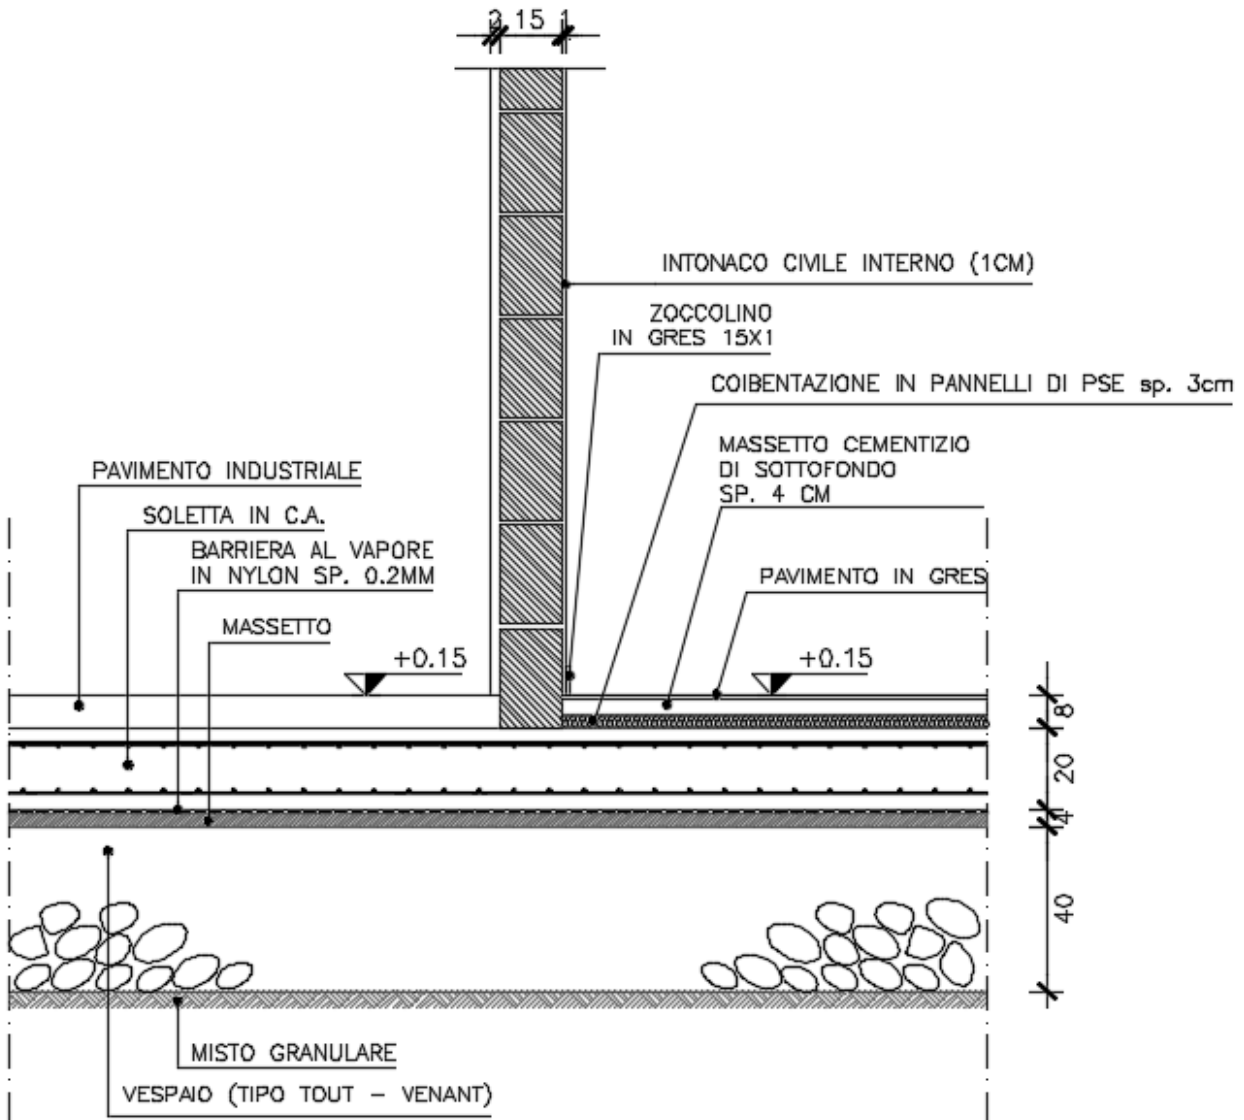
Particolare pavimentazione tra officina e locale batteria
